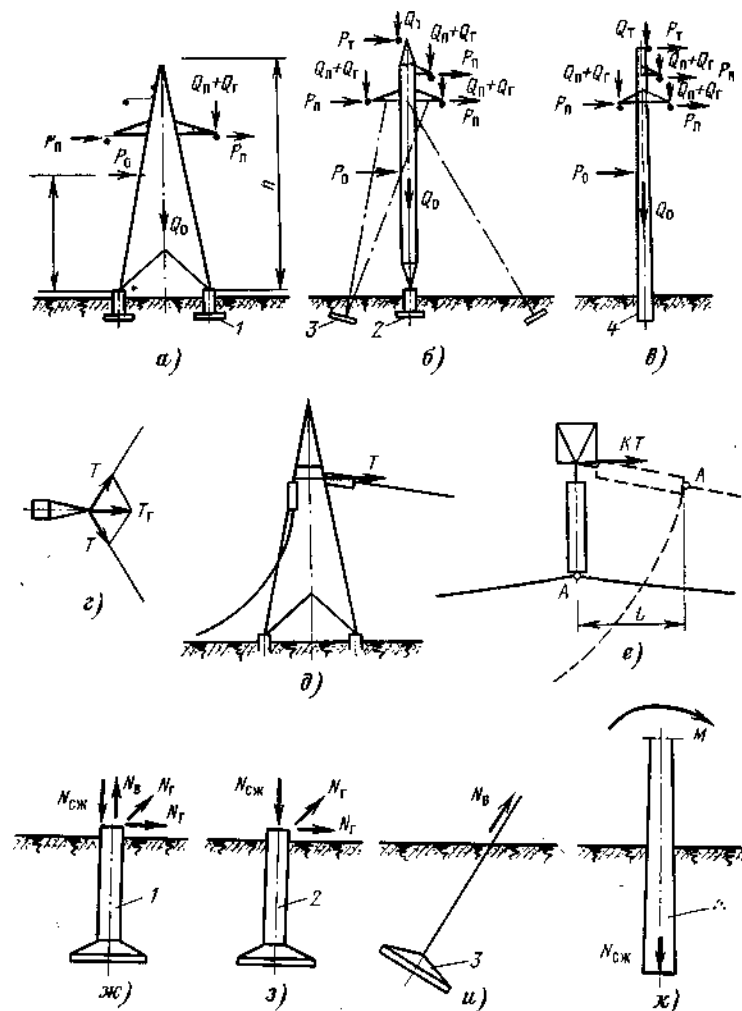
Навантаження на опори та їх фундаменти.
